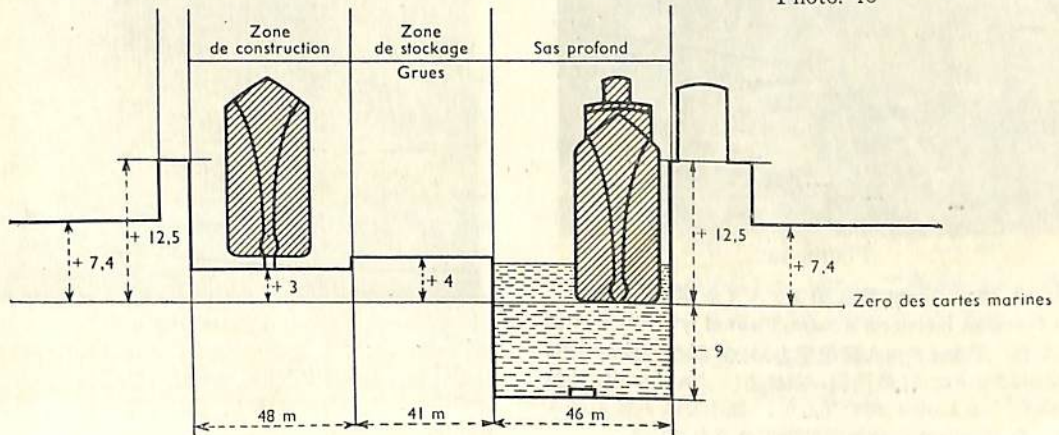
Jean Bart Building Dock は1936年に完工し、長さは325 M、前頁下図の断面の示すように非常に characteristic である。
